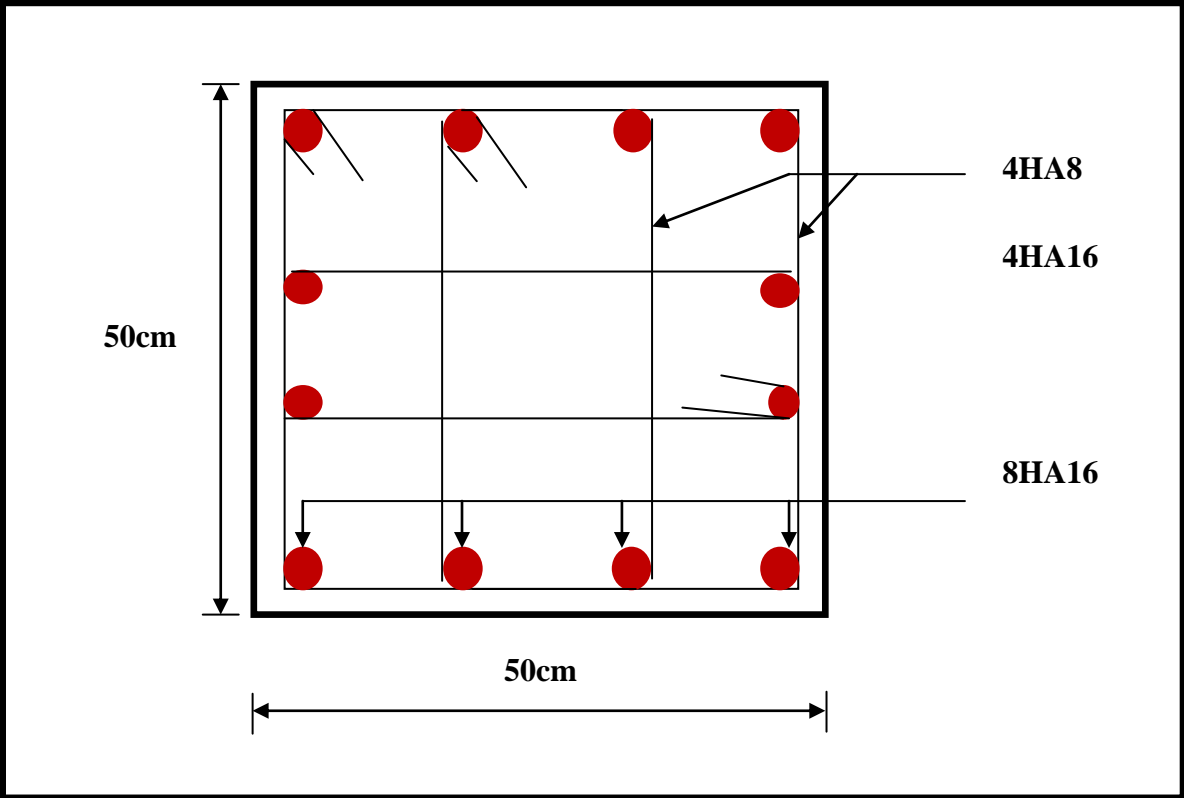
Ferrailage Poteau 50 × 50
